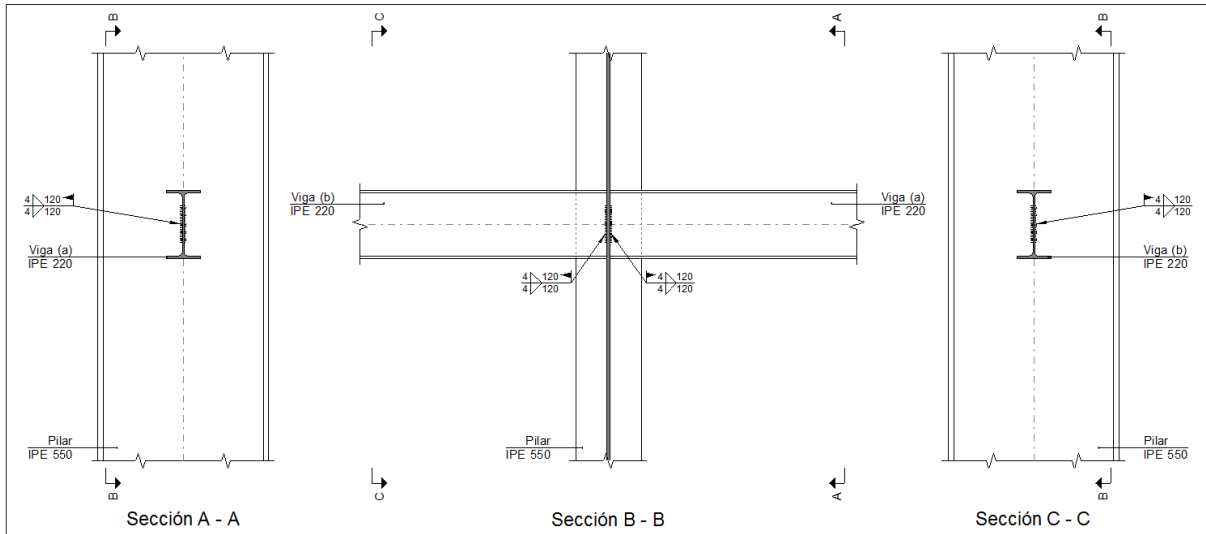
Detalle de unión entre pilar y viga perimetral, tipo 7 (CYPE)
